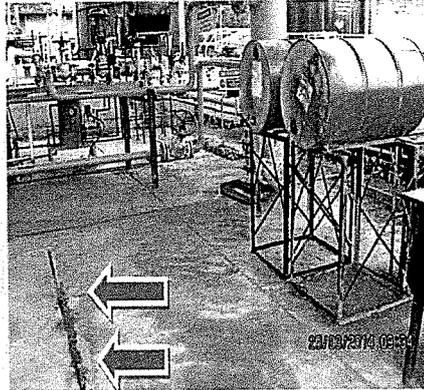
E367105 N9696762 / Área de inyección de químicas – Batería Dorissa / Yacimiento Dorissa.
